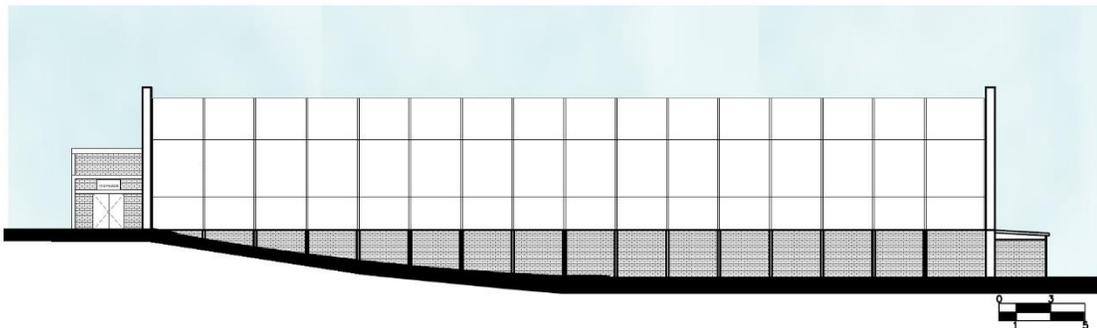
Fachada actual Sur; vista de acceso al invernadero a la izquierda.
